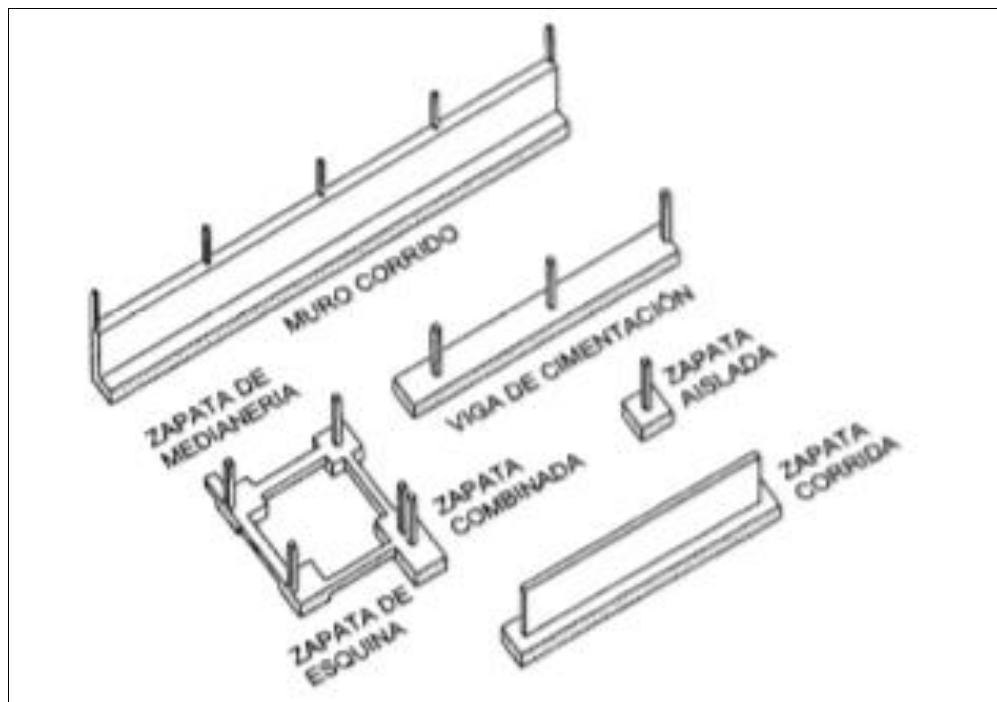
Zapatas Muros y vigas. Fuente: Calavera, 1982.
